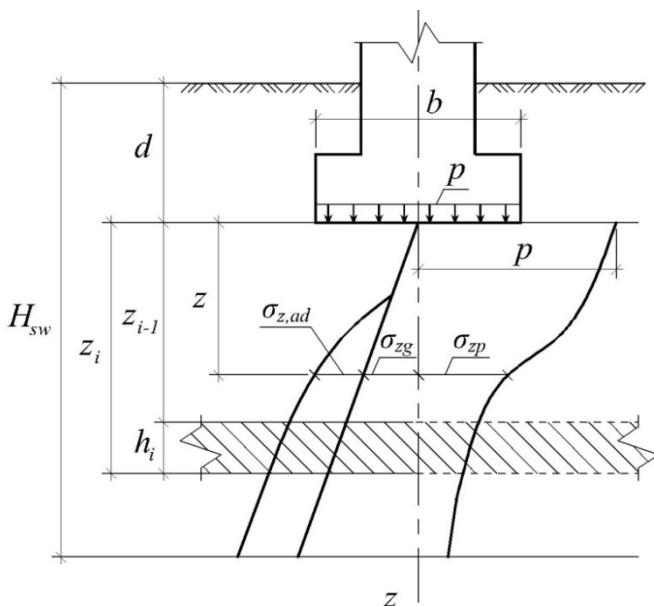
Схема к расчету подъема основания фундамента при набухании грунта
